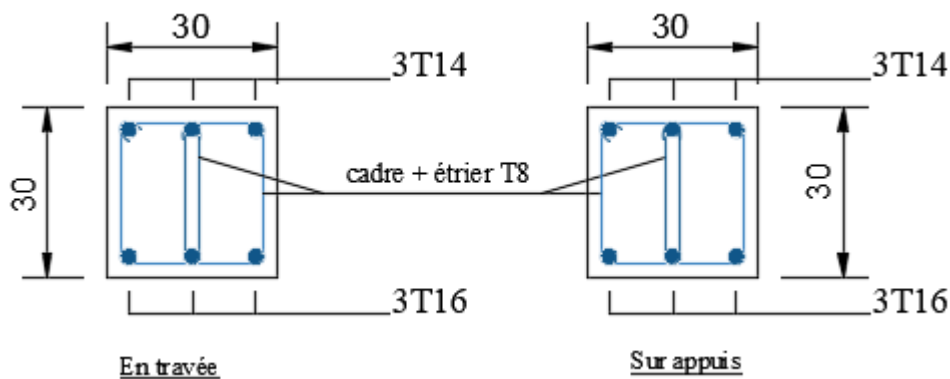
Schéma de ferrailage de la poutre palière.
